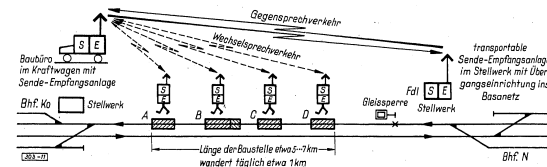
Oberbau-Großbaustelle. A. Betungs-Reinigungsmaschine, B. Portalkran mit Arbeitszug, C. Planiergerät, D. Schwellenverlegung, Schienentrupp. Das Baubüro hat mit allen Baustellen-Abschnitten und dem nächsten Bahnhof Funkensprechverbindung
